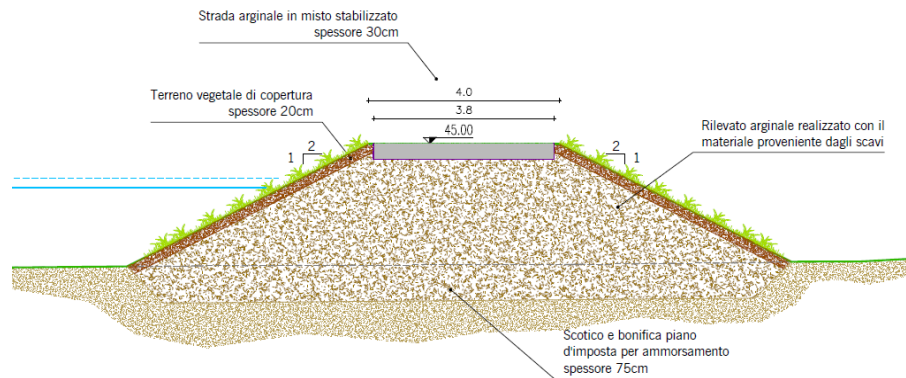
Sezione tipo del rilevato arginale della cassa di espansione
